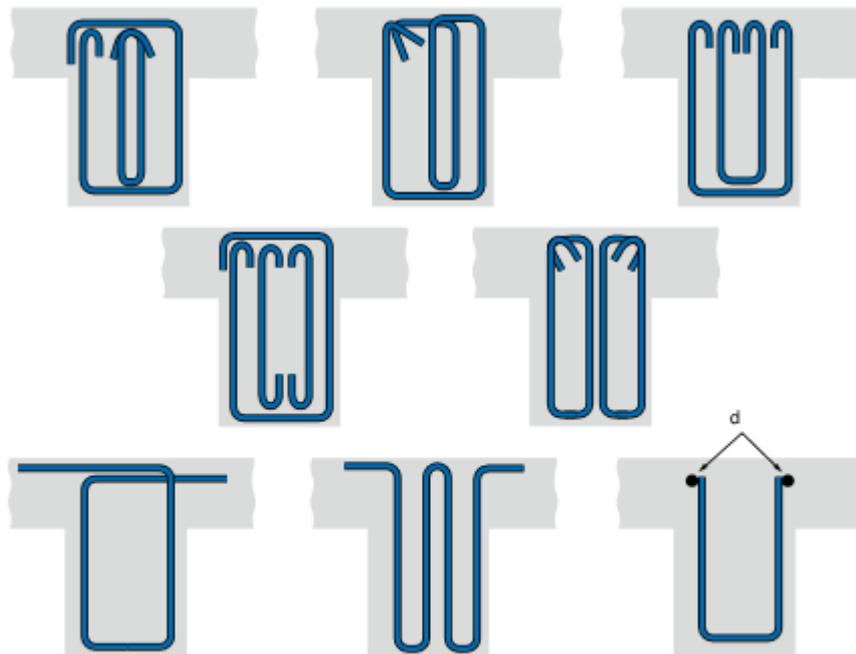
Les armatures transversales de poutres fléchies Conforme à la norme NF EN 1992-1-1 [18].
